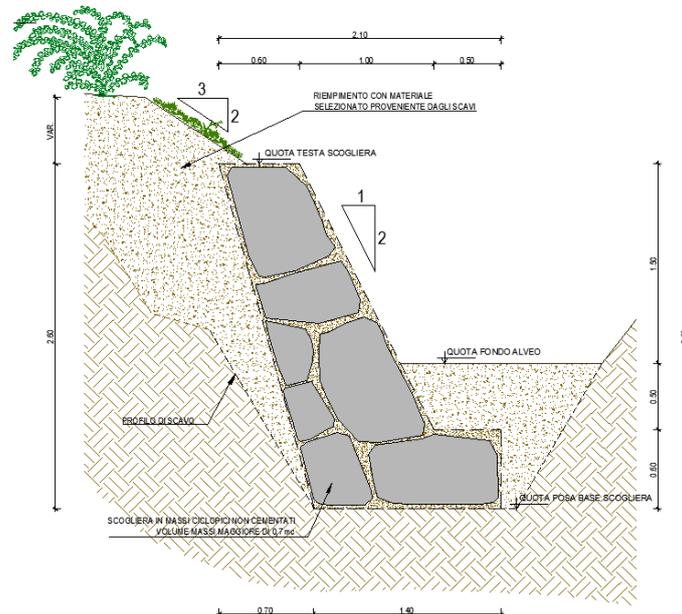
Sezione tipo difesa longitudinale in scogliera (sponda sinistra).
